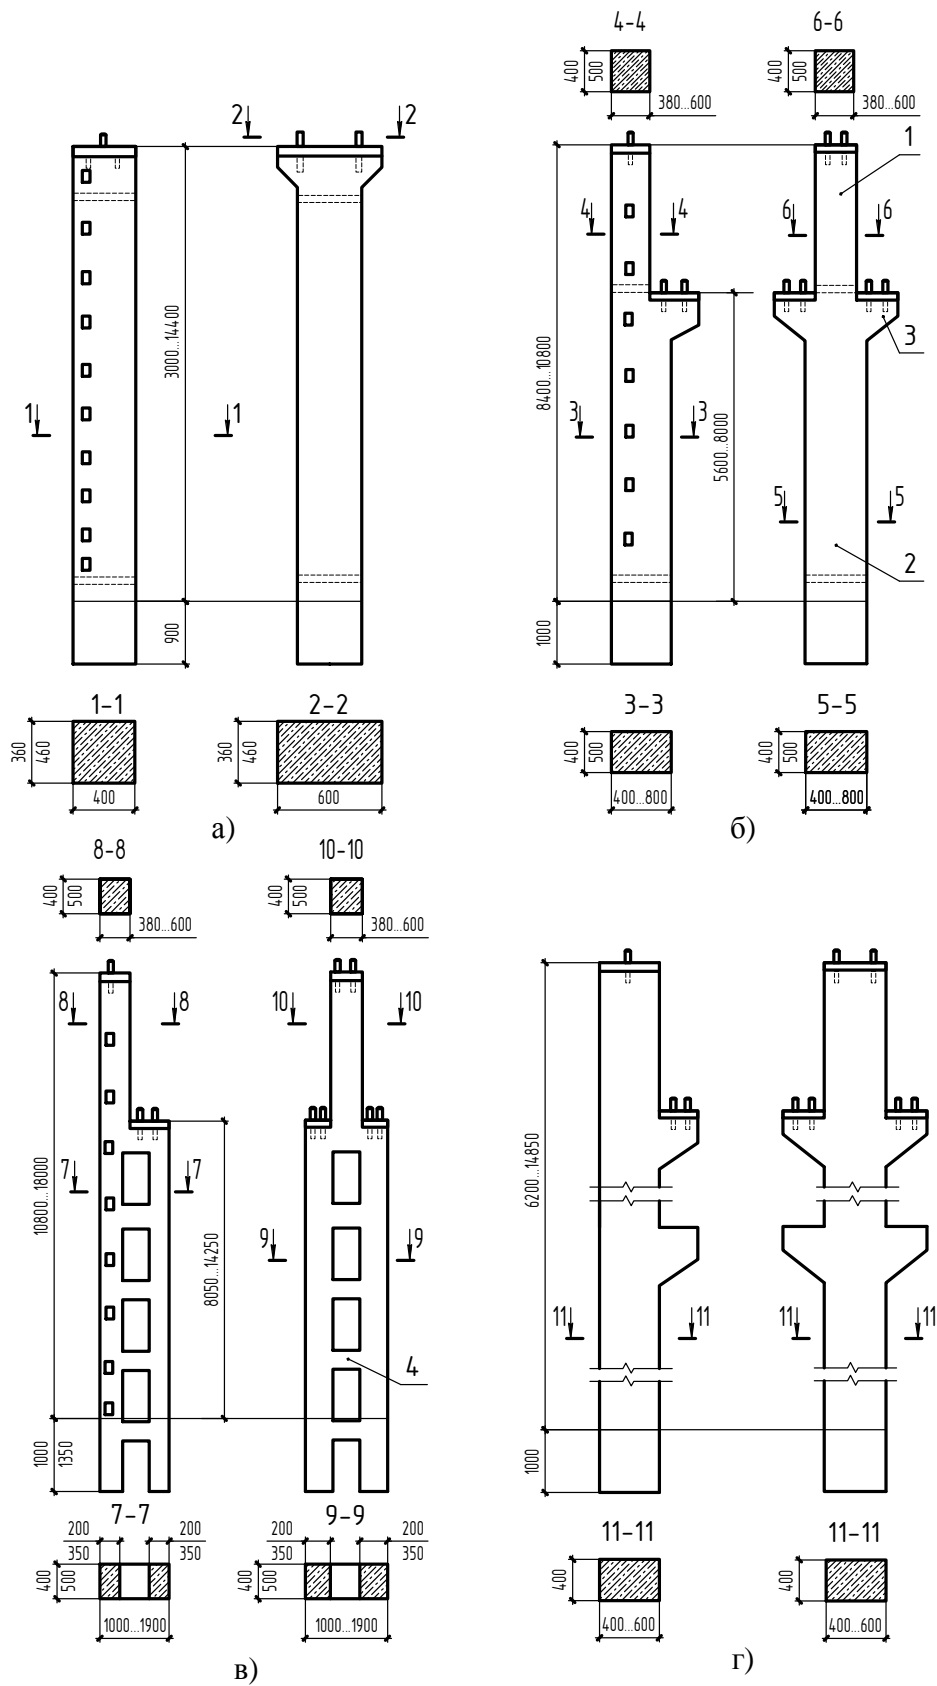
(а, б, в, г). Типы железобетонных колонн промышленных зданий: 1 – верхняя часть колонны; 2 – нижняя часть колонны; 3 – консоль; 4 – распорка
